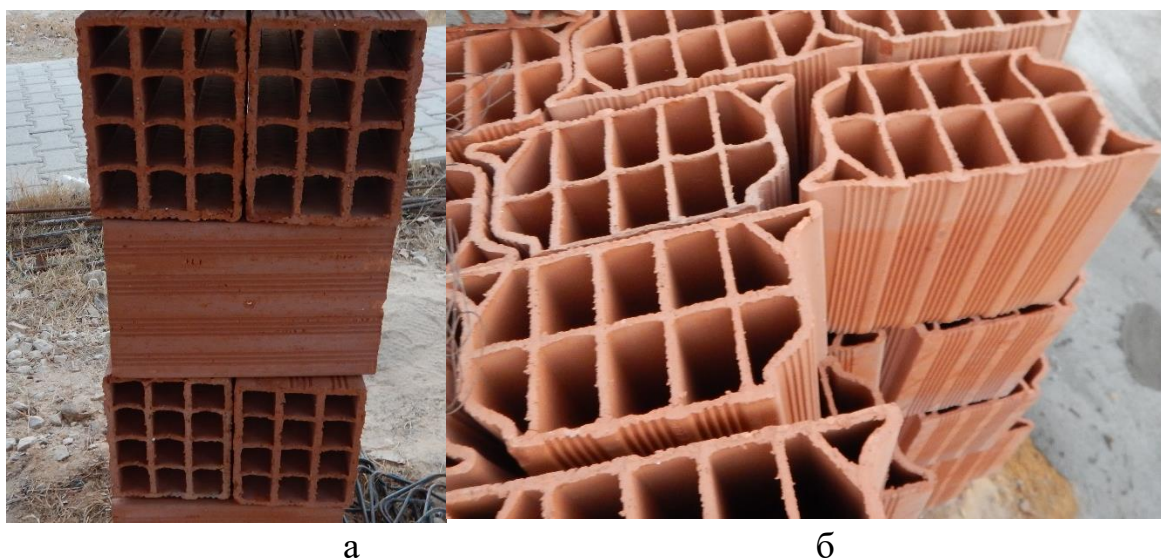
Высоко пустотные керамические камни с горизонтальными пустотами: а – для стеновой кладки; б – межэтажных перекрытий
